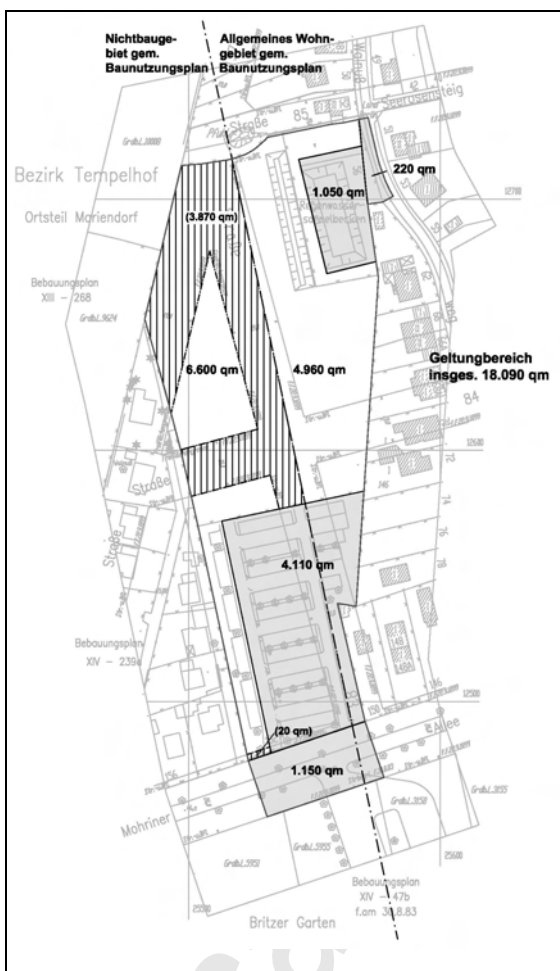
Flächenbilanz vorhandenes Planungsrecht
